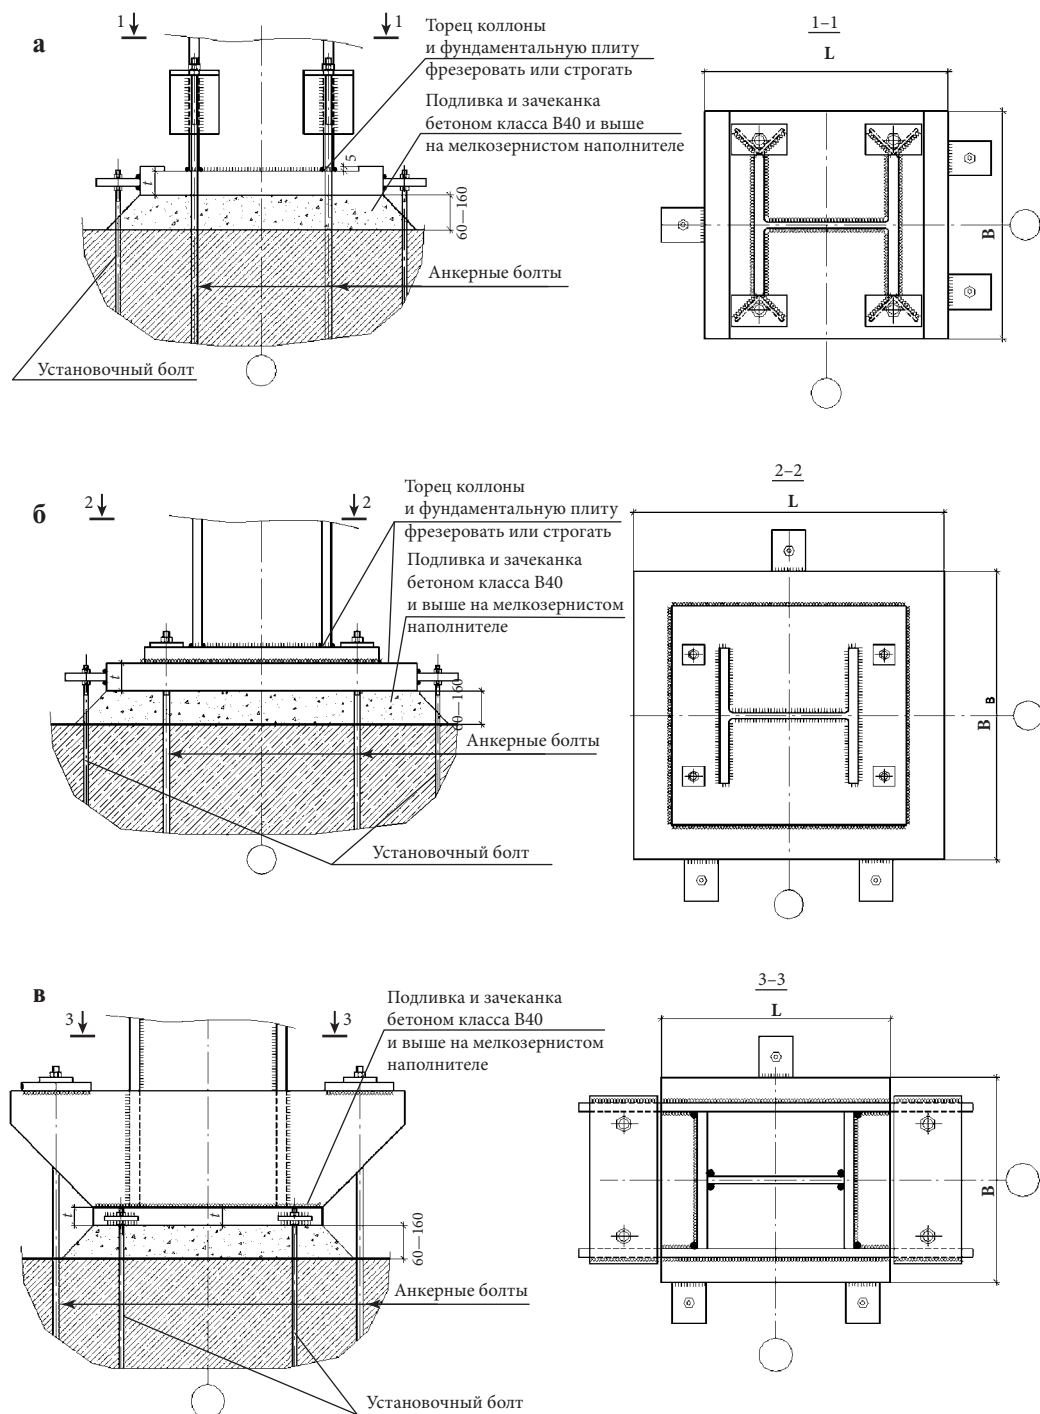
Жёсткие узлы крепления колонны многоэтажного здания: а) база с фрезерованным торцом, одной фундаментной плитой и креплением анкерных болтов к полкам колонны; б) база с фрезерованным торцом, двумя фундаментными плитами и креплением анкерных болтов к фундаментным плитам; в) базы с траверсами
